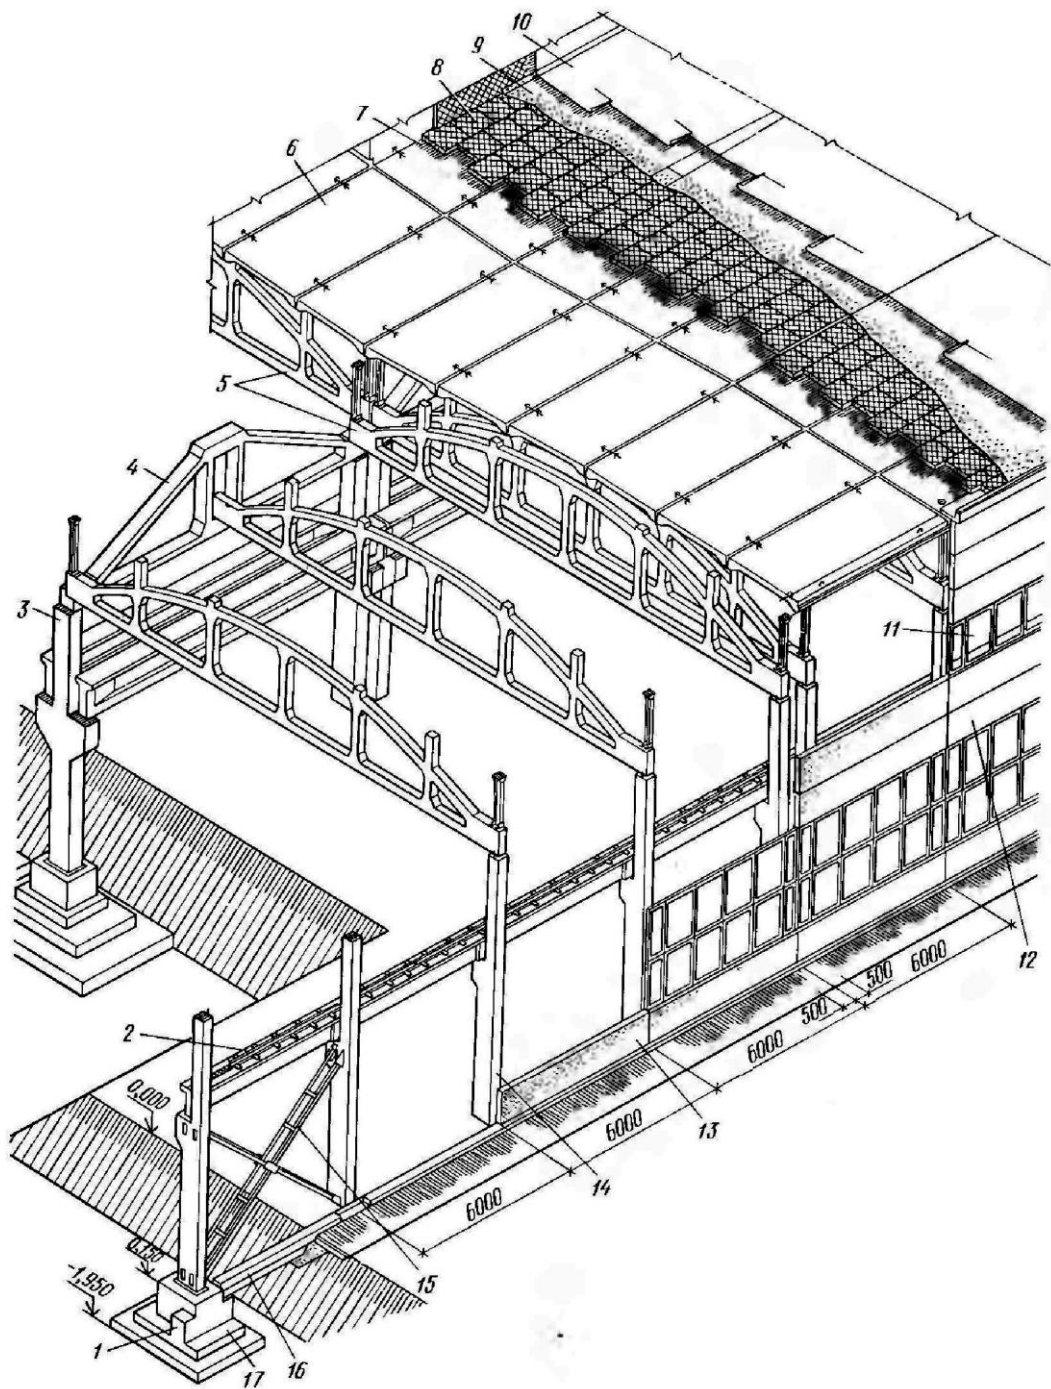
Конструктивне рішення одноповерхової багатопролітної виробничої будівлі [1]: 1 – бетонний підлив для оперття фундаментних балок; 2 – підкранова балка; 3 – колона середнього ряду; 4 – підкроквяна залізобетонна ферма; 5 – безрозкісна залізобетонна ферма; 6 – плита покриття; 7 – пароізоляція; 8 – утеплювач; 9 – цементна стяжка; 10 – багат шаровий руберойдовий килим; 11 – засклення; 12 – стінова панель; 13 – цокольна панель; 14 – колона крайнього ряду; 15 – металевий хрестовий вертикальний зв'язок між колонами; 16 – фундаментна балка; 17 – фундамент
